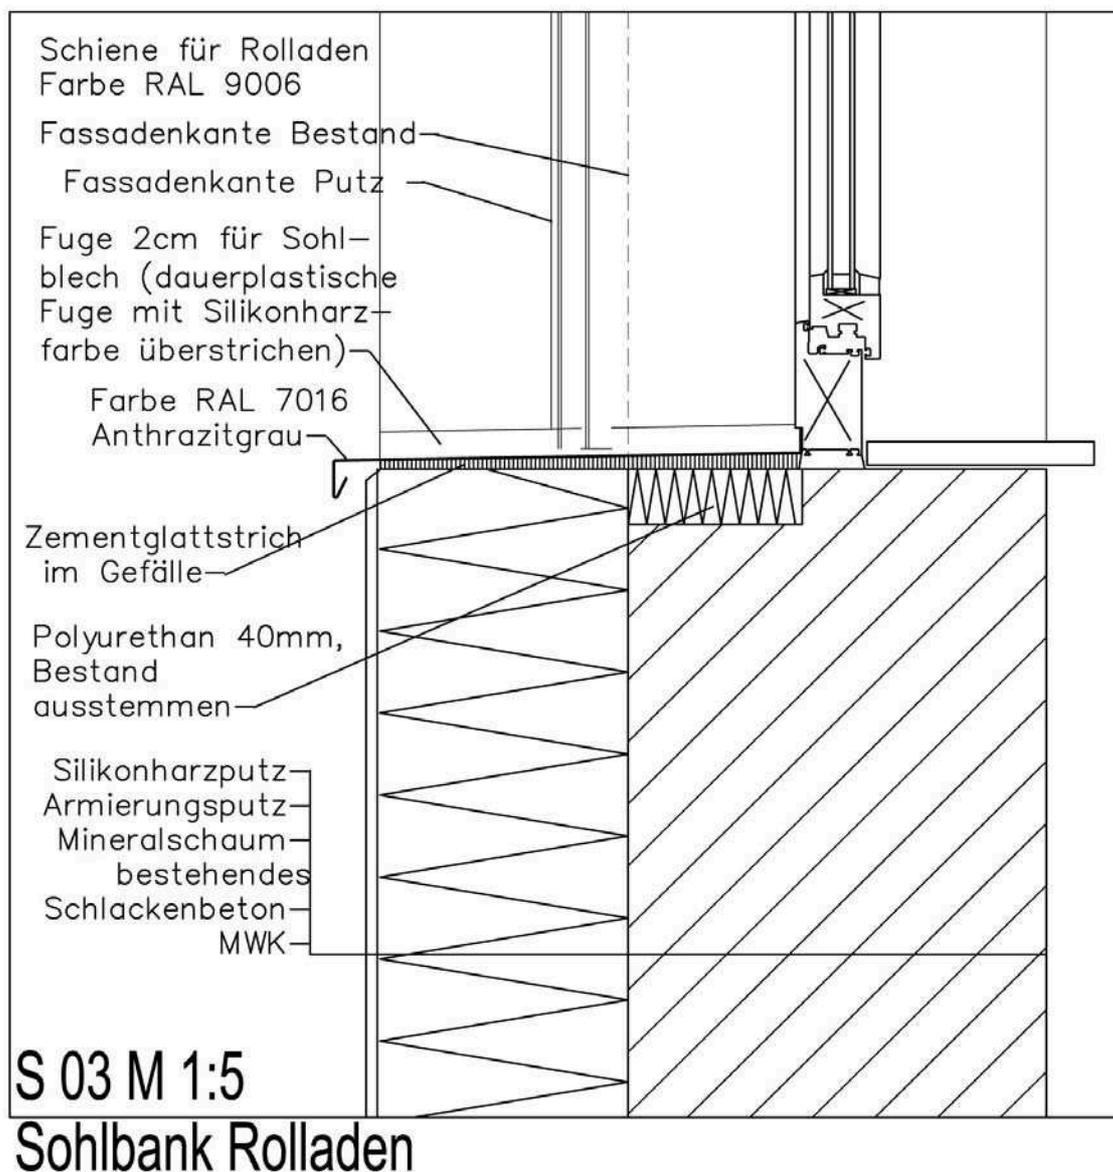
Detail S03 Vertikaler unterer Fensteranschluss
